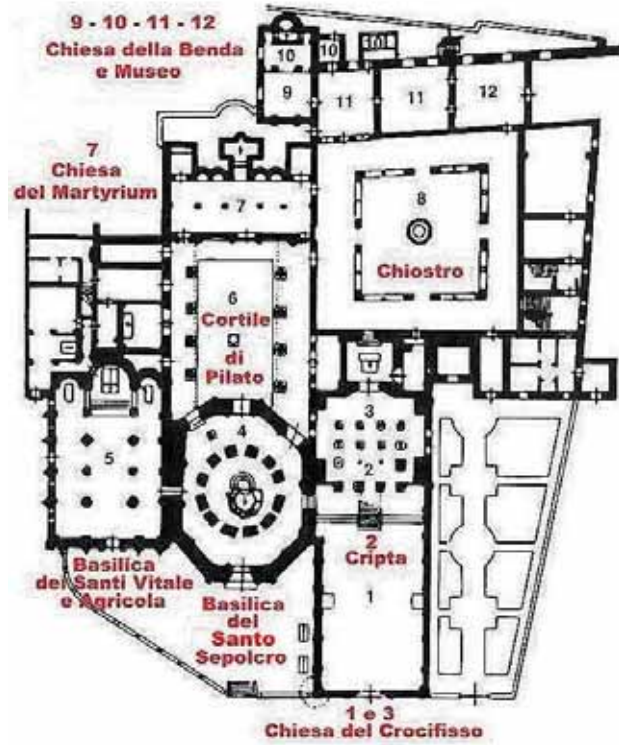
26 Grundriss der *Basilica Santo Stefano
